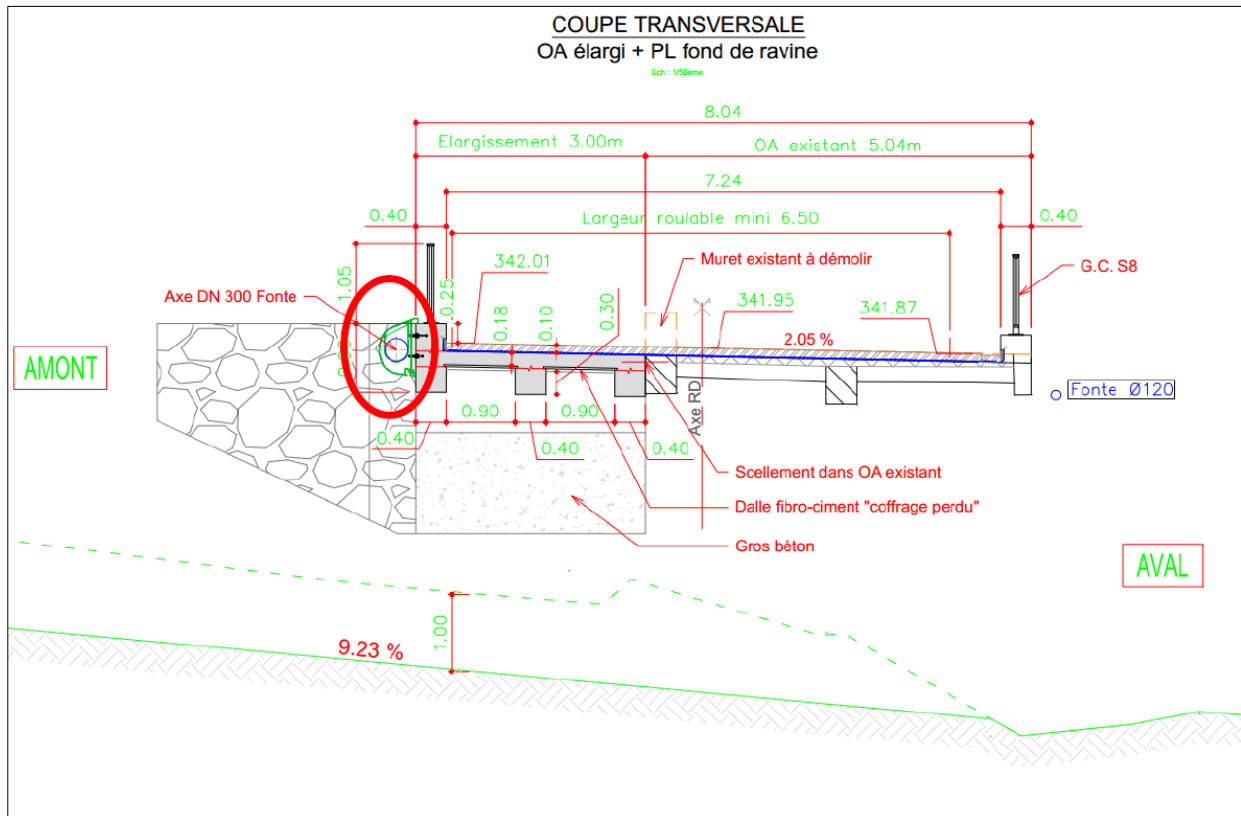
Projet d'élargissement de l'ouvrage de la route Hubert Delisle-Coupe transversale (Sources TPIC-AVP-02/2020)
